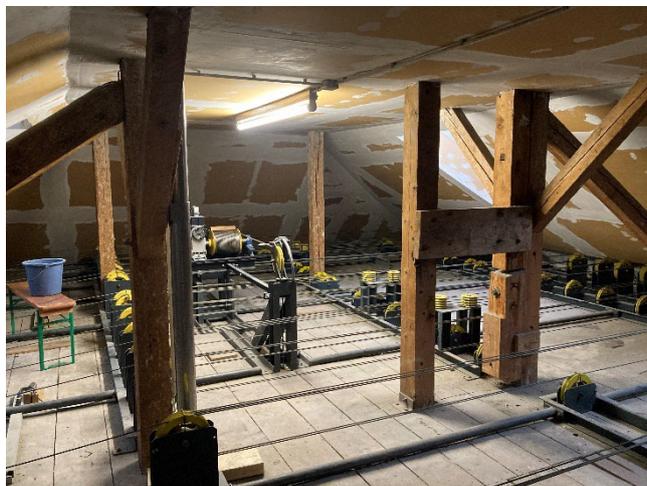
Teilweise gedämmtter Dachstuhl über dem Bühnenbereich.
